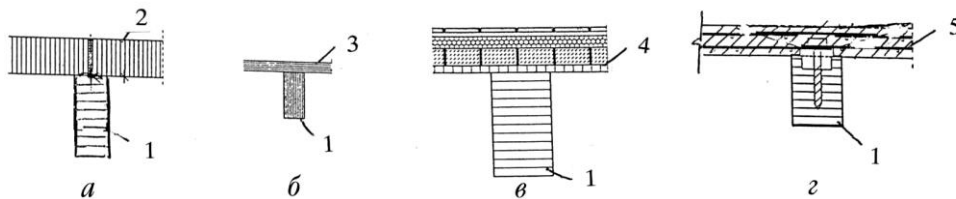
Варианты ребристых покрытий: 1 – клеодощатые или склеенные из шпона балки; 2 – деревоплита составного сечения из пакета досок или брусьев; 3 – плита, склеенная из шпона; 4 – комплексная деревоплита; 5 – железобетонная плита
